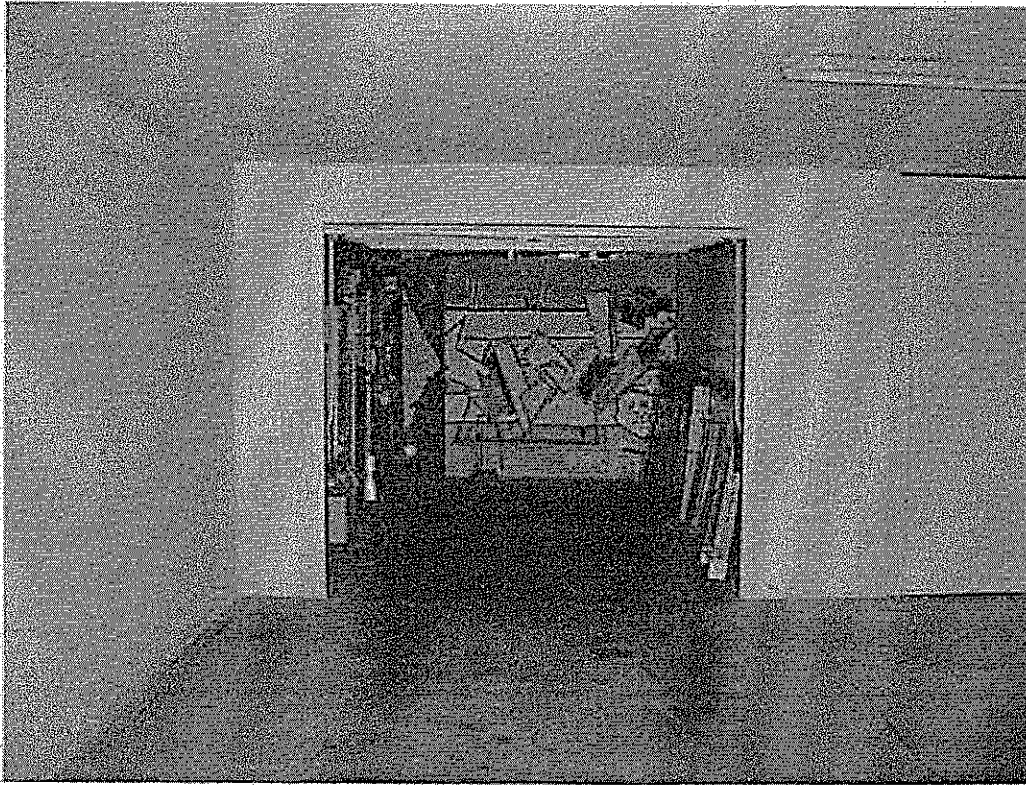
Come foto N° 20 con vista dalla corsia di manovra comune.
